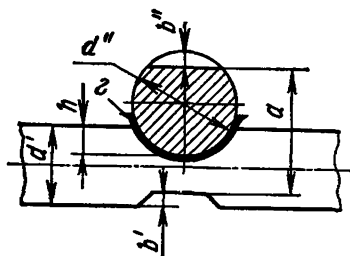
Схема крестообразного сварного соединения, выполненного контактной точечной сваркой:
